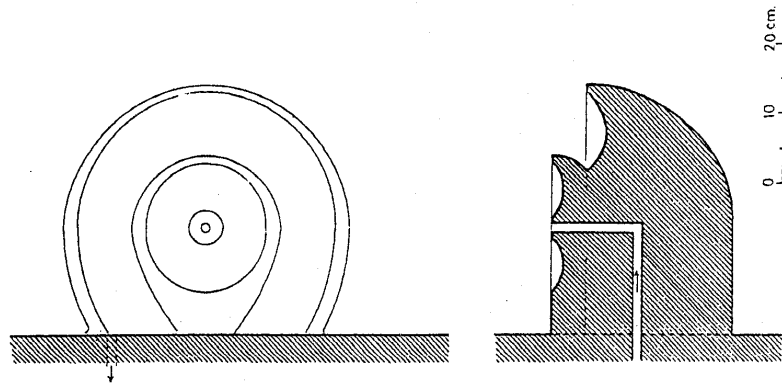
مسقط أفقي لجشمة غلبهار خاتون
